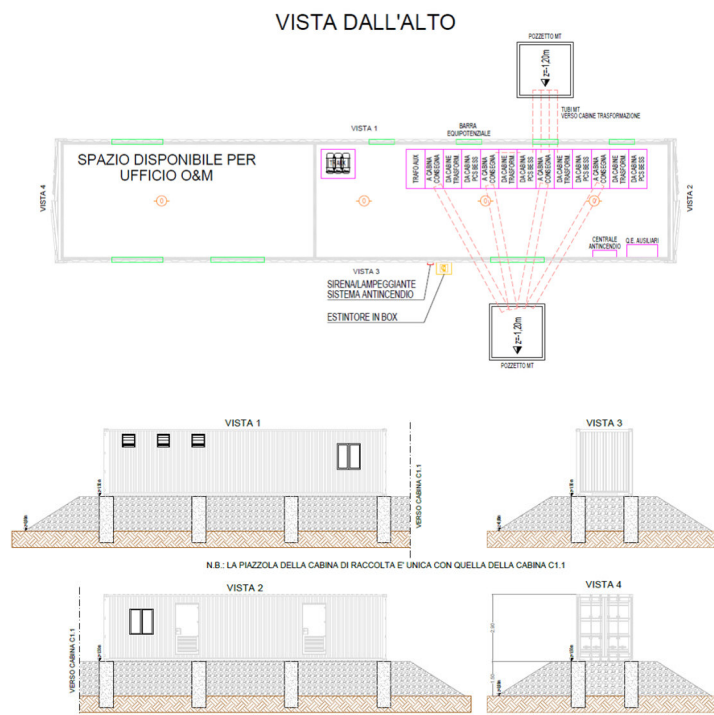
Cabina di Raccolta – Pianta, prospetti e sezioni tipo
